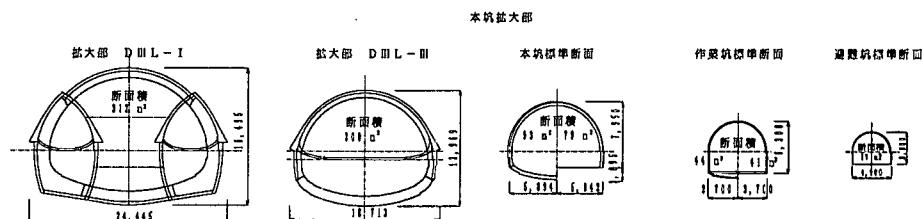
本坑・作業坑標準断面およびランプ部拡大断面図
